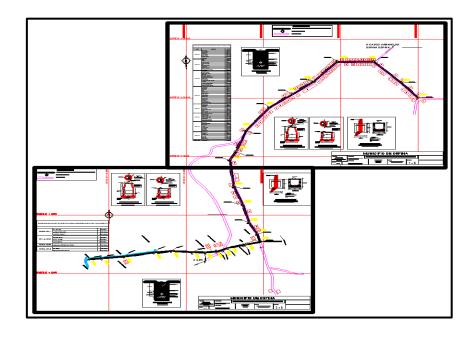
LÍNEA DEL ALCANTARILLADO SAN ISIDRO
